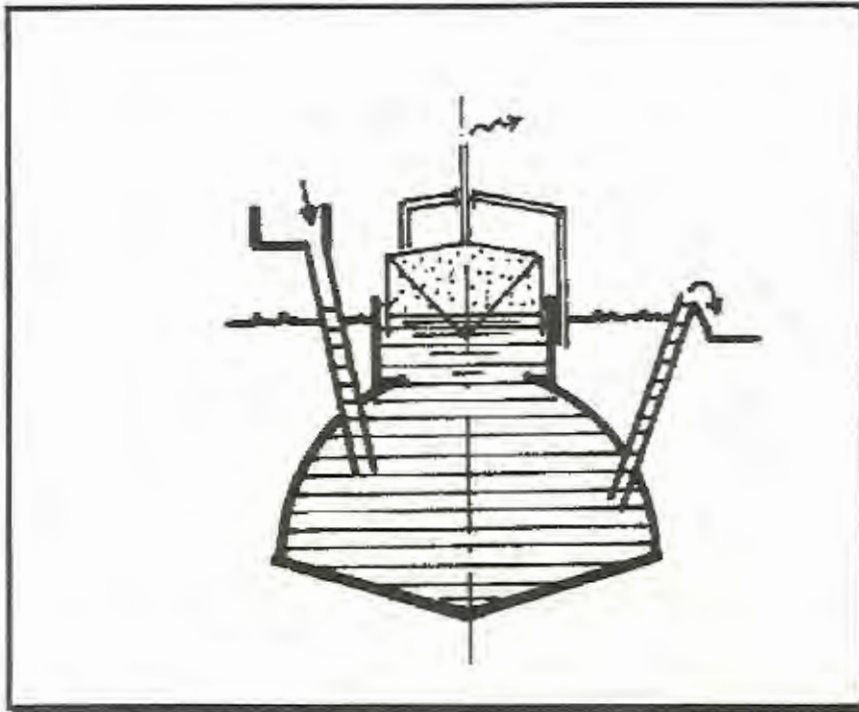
PLANTA CON CAMPANA FLOTANTE. FUENTE:
